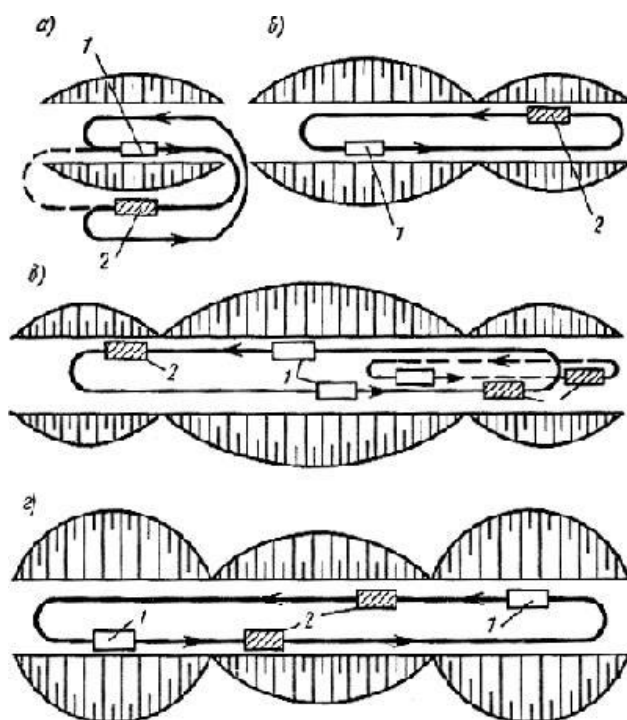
Эллиптическая схема движения скреперов: в отвал (а); в смежную насыпь (б); из выемки в две насыпи (в); из двух выемок в насыпь (г):
